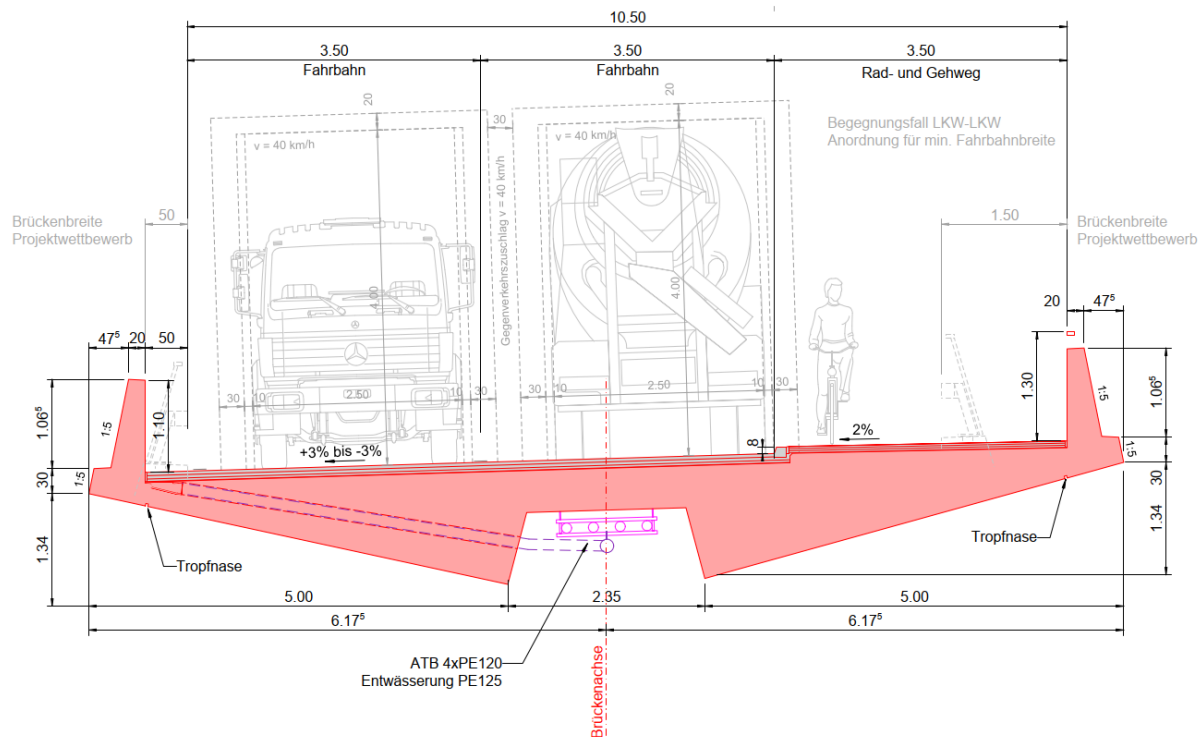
Querschnitt Überführung Bernstrasse Ost B-178, Gegenüberstellung Brückenquerschnitt Stand Projektwettbewerb und Stand Bauprojekt.
